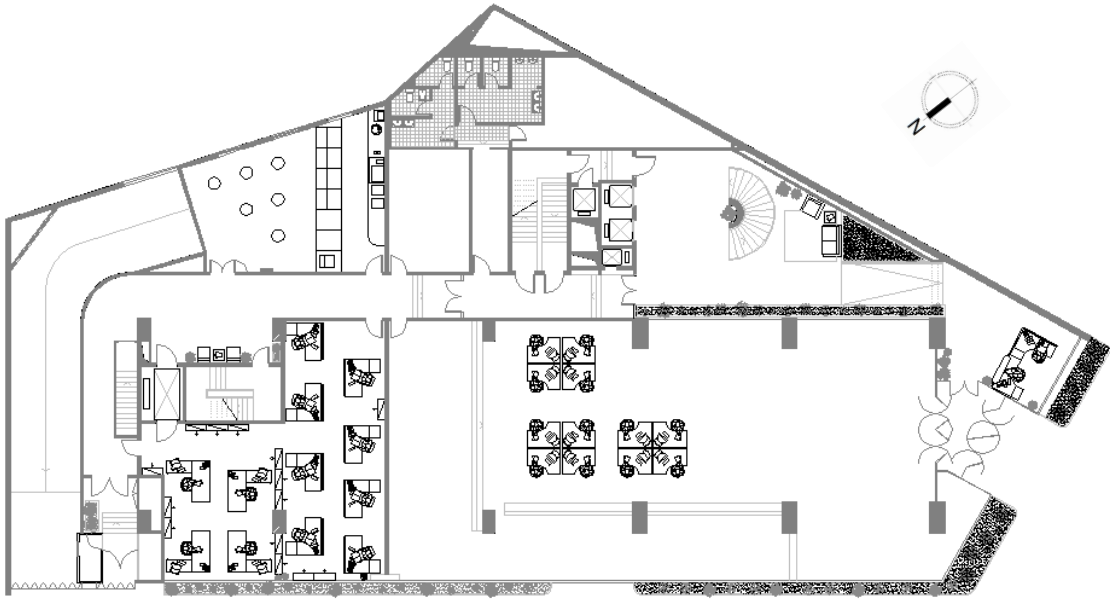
Planta do Piso 0 (Reservado, 2016)
